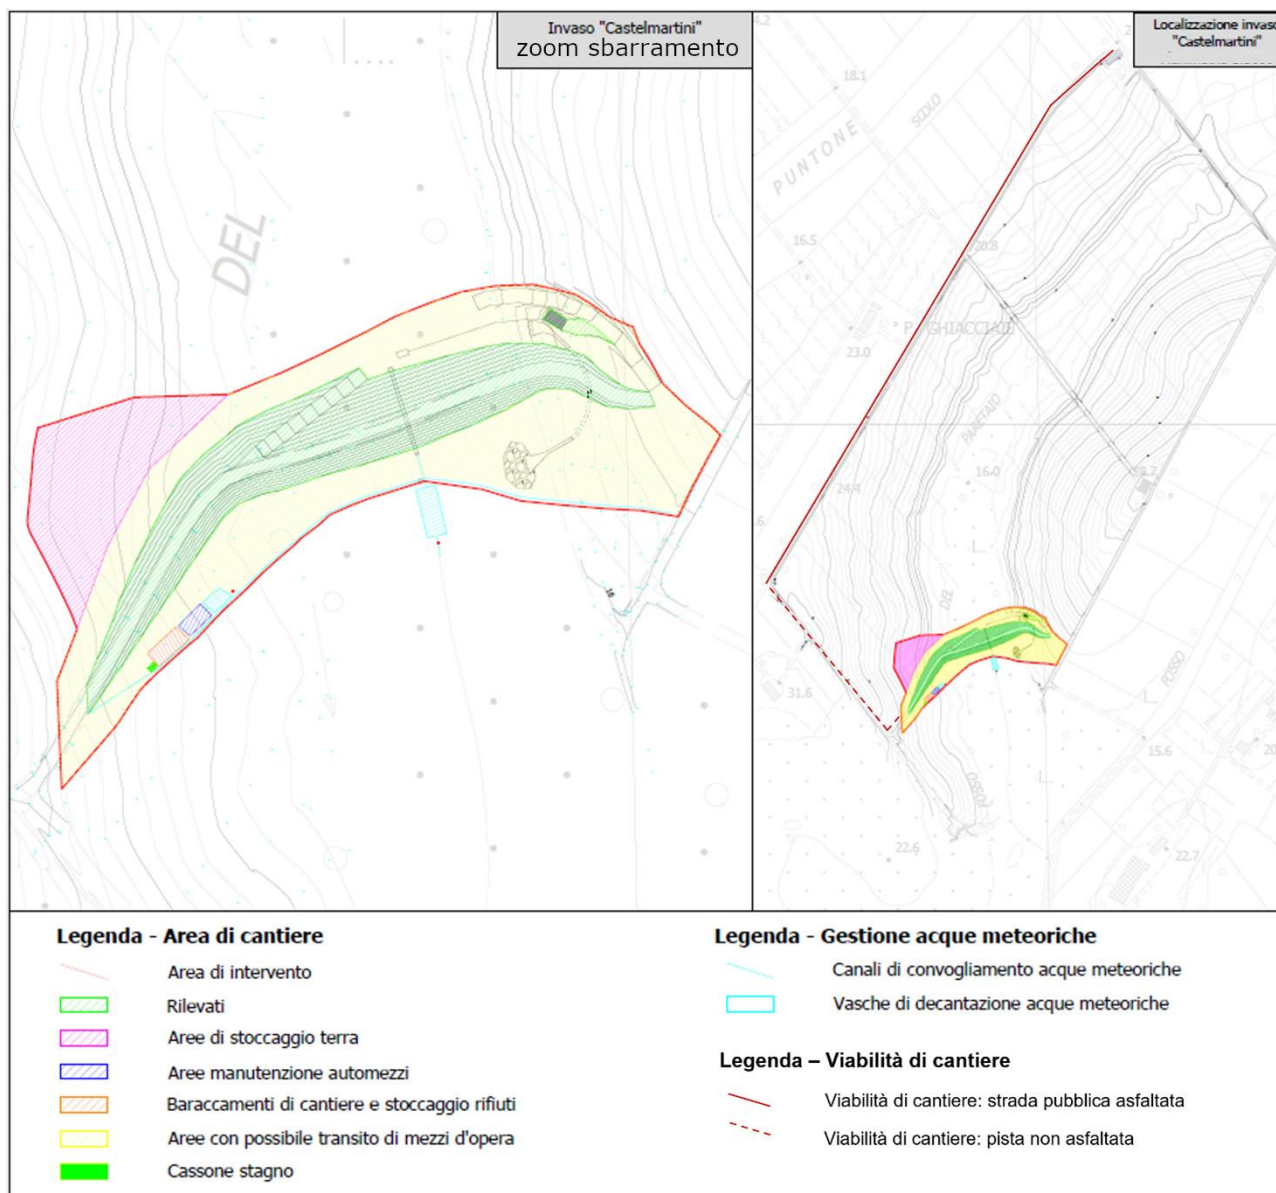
estratto dalla tavola di progetto Tav J1 - Piano convogliamento amd - planimetrie_febbraio_2020
